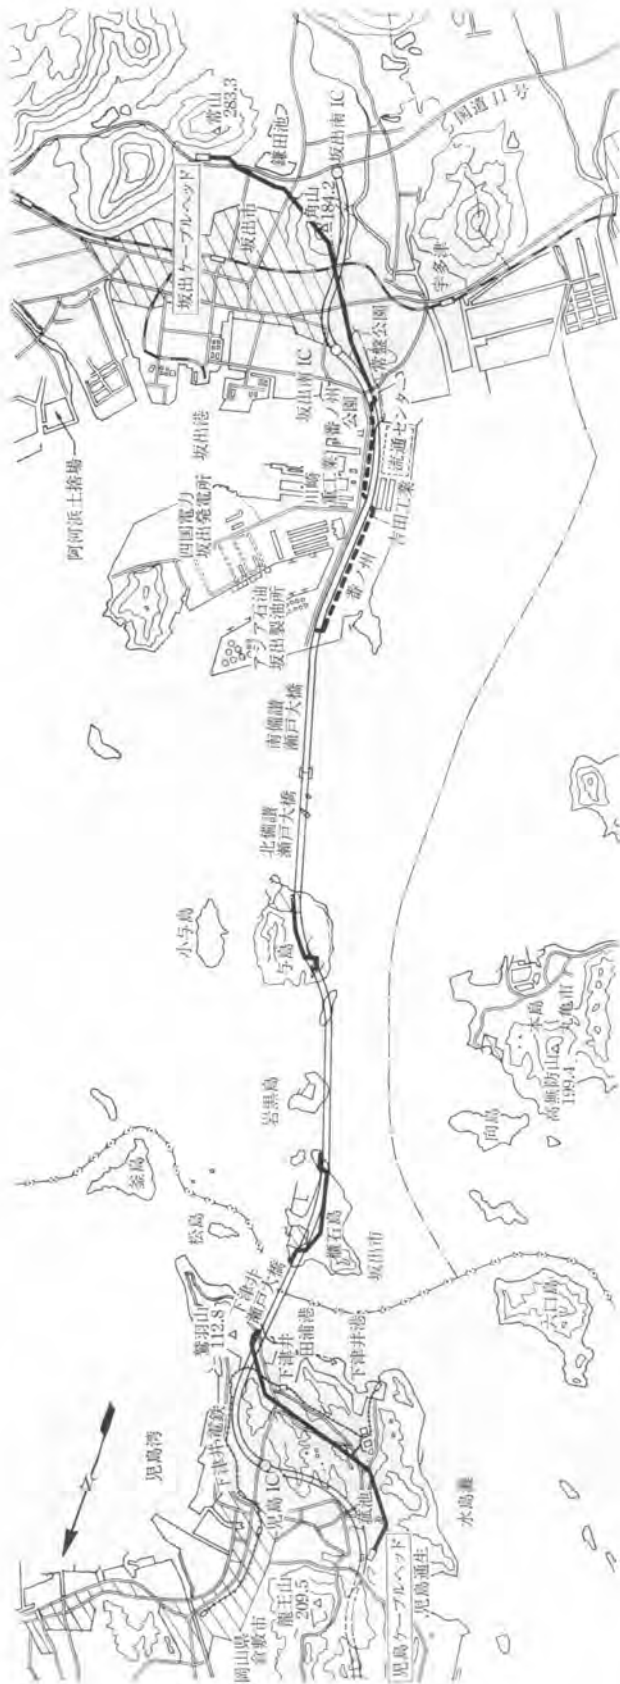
洞道およびケーブル橋梁添架概要図 (平面)
